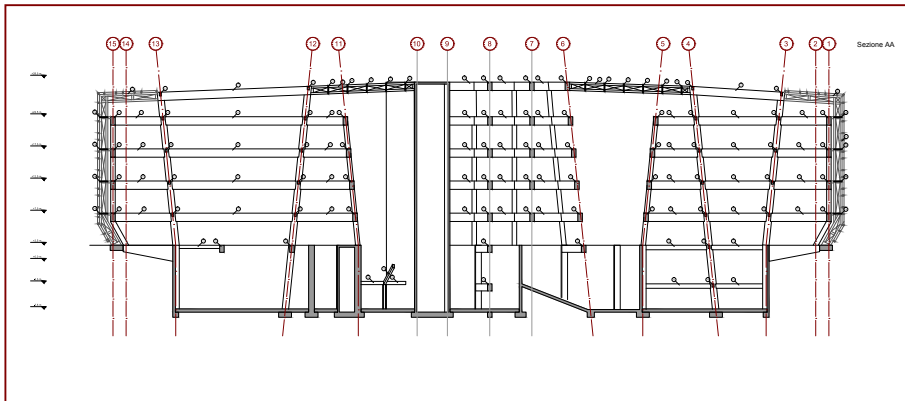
Sezione longitudinale secondo l'asse strutturale C.
